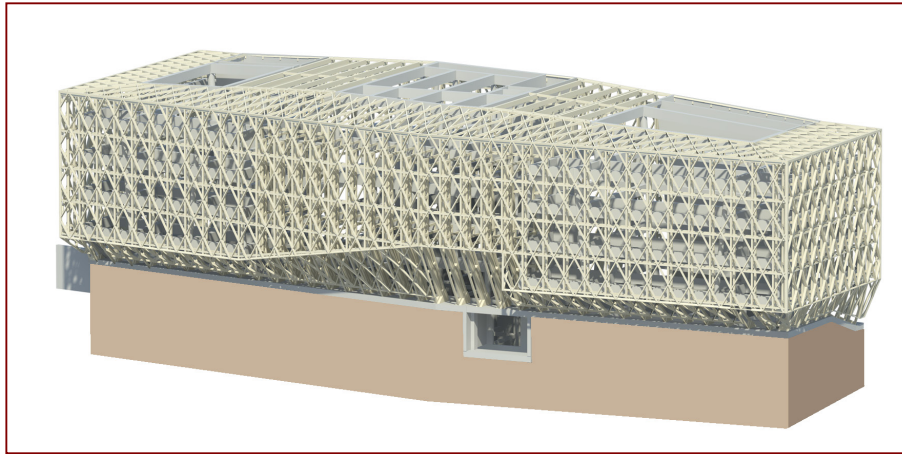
3D strutturale - Struttura in losanghe della facciata.
